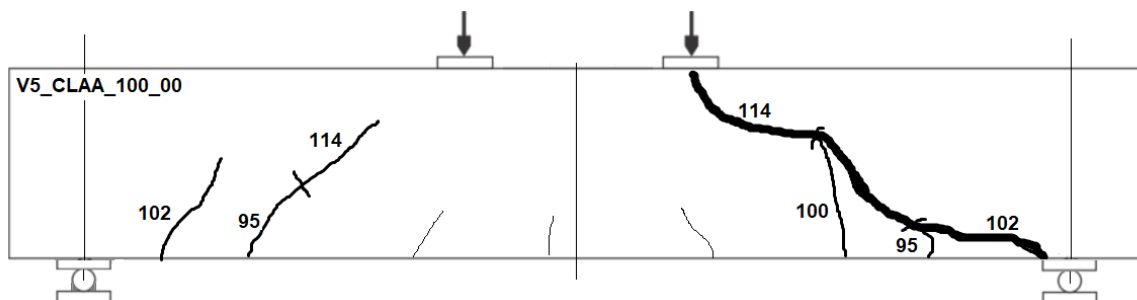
Esquema de fissuração da Viga 5_CLAA_100_00.
